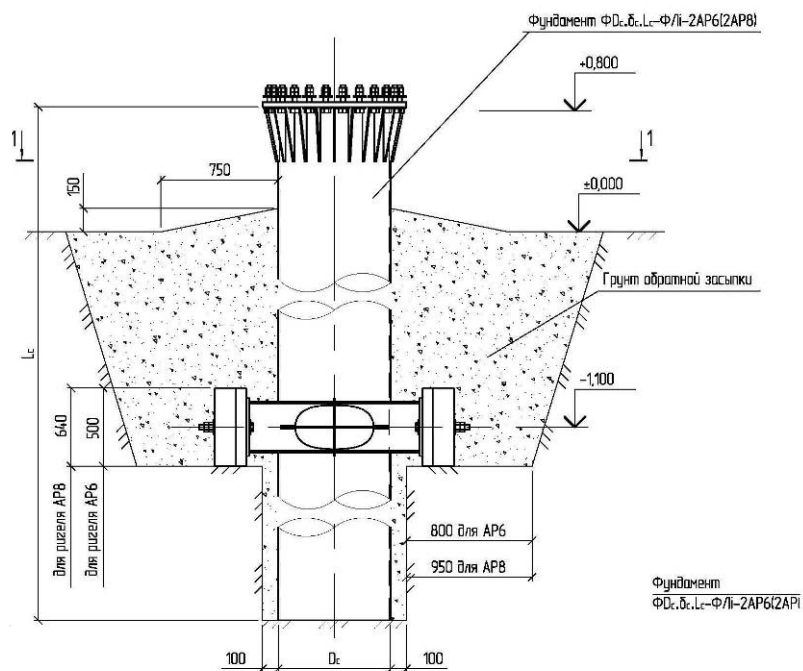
Фундамент из сваи-оболочки, усиленный двумя ригелями. Схема установки.
